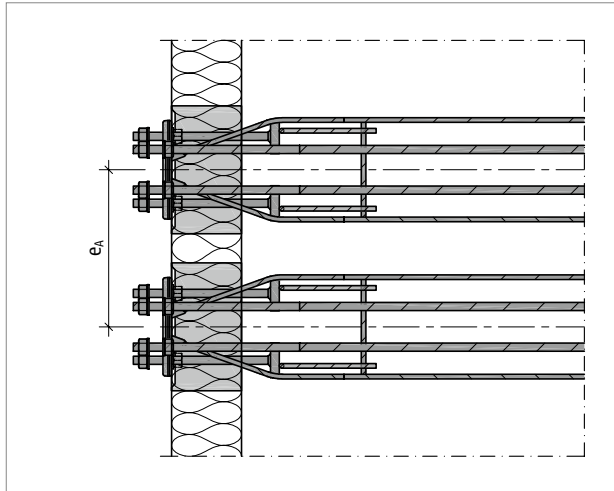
Schöck Isokorb® XT type SK : espacement axial
